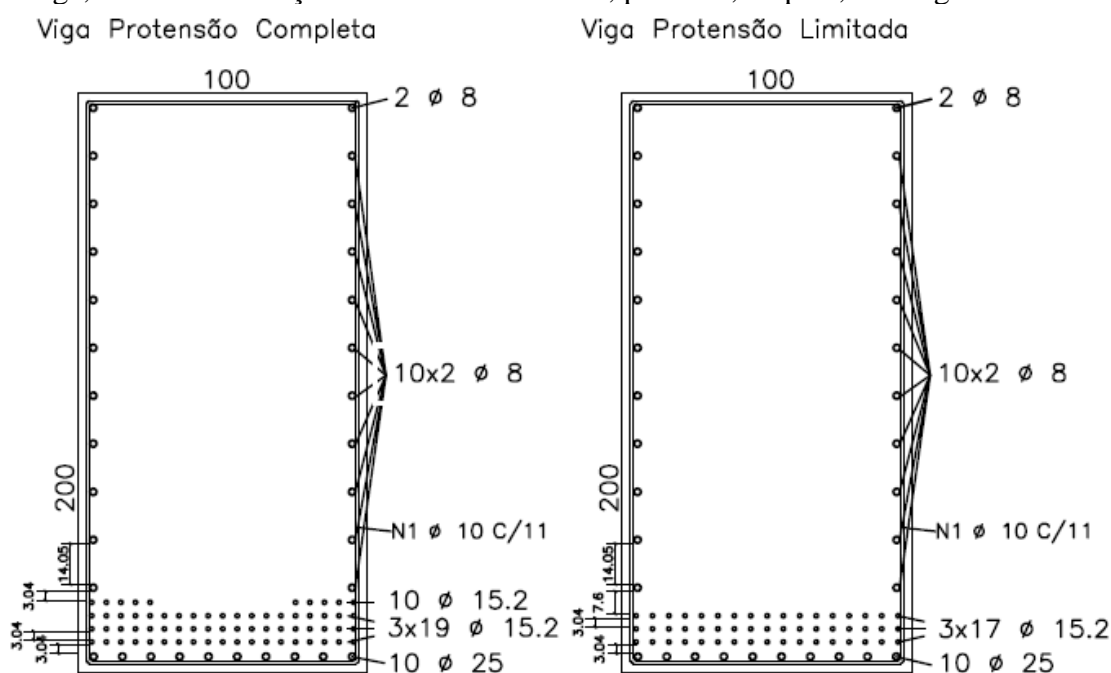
Croqui da seção transversal das vigas em concreto protendido.
